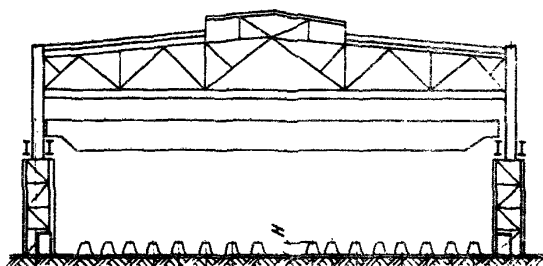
Размещение участка для сборки и сварки конструкций в поперечном пролете
